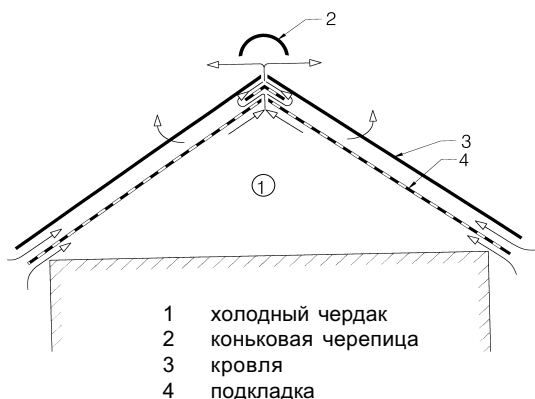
Принципиальная схема вентиляции чердачной крыши.
